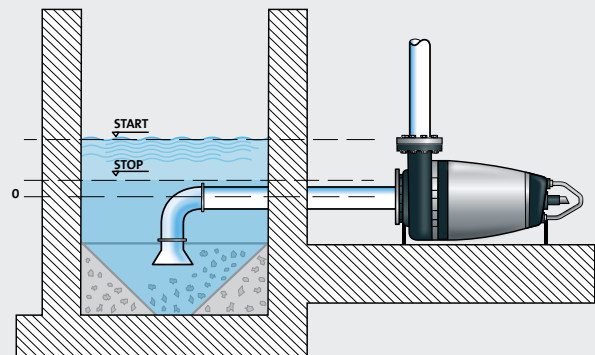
Tauchbare horizontale Trockeninstallation mit Bügeln zur Befestigung am Fundament
